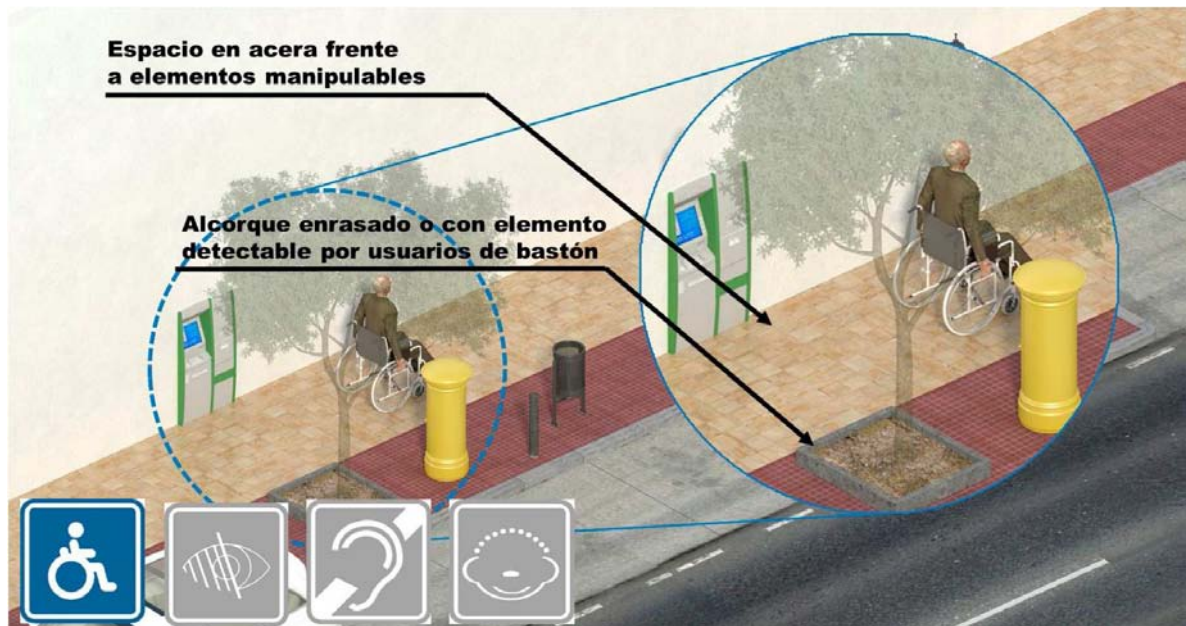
Detalles de diseño. Uso de pavimentos e iluminación
